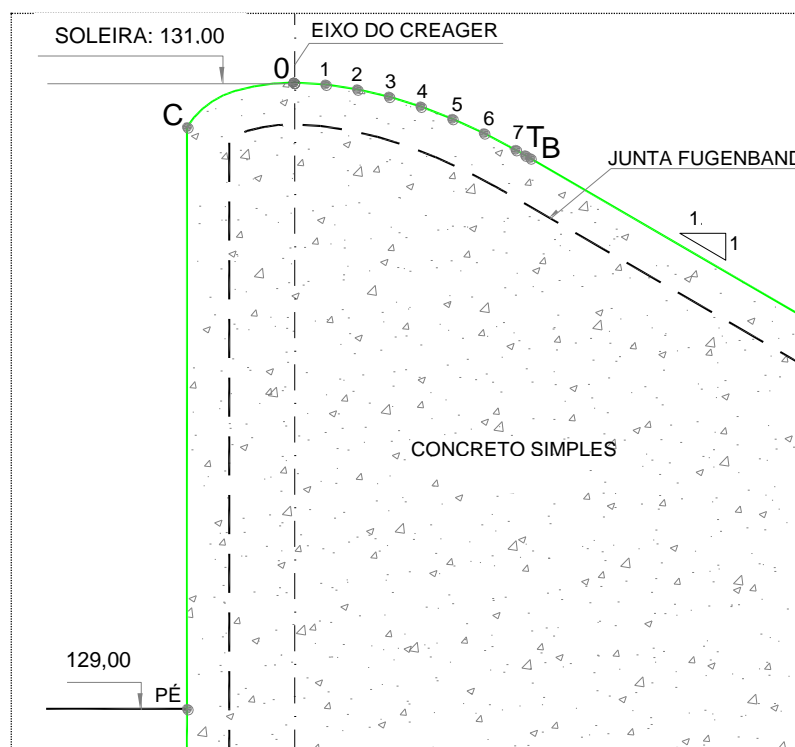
Coordenadas dos Pontos do Perfil Creager
